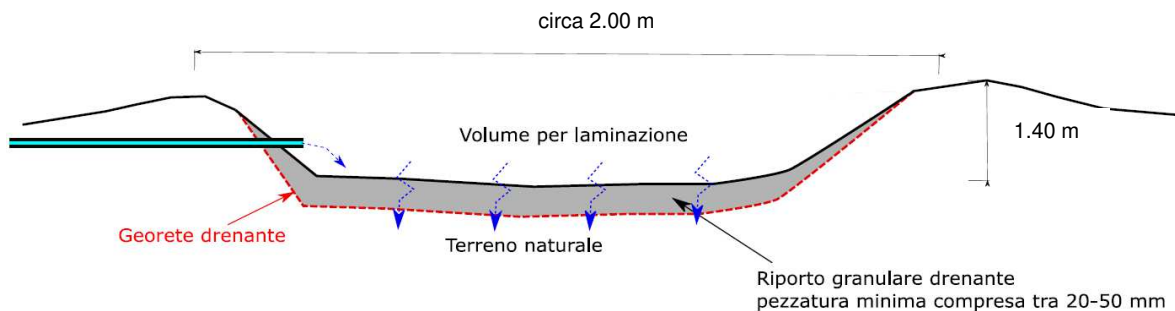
Schema indicativo sezione trasversale area laminazione.
